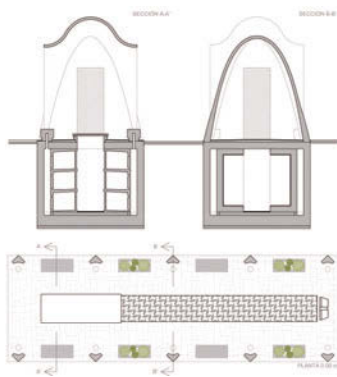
/ Planta de distribución y secciones transversales (Vegas & Mileto).
